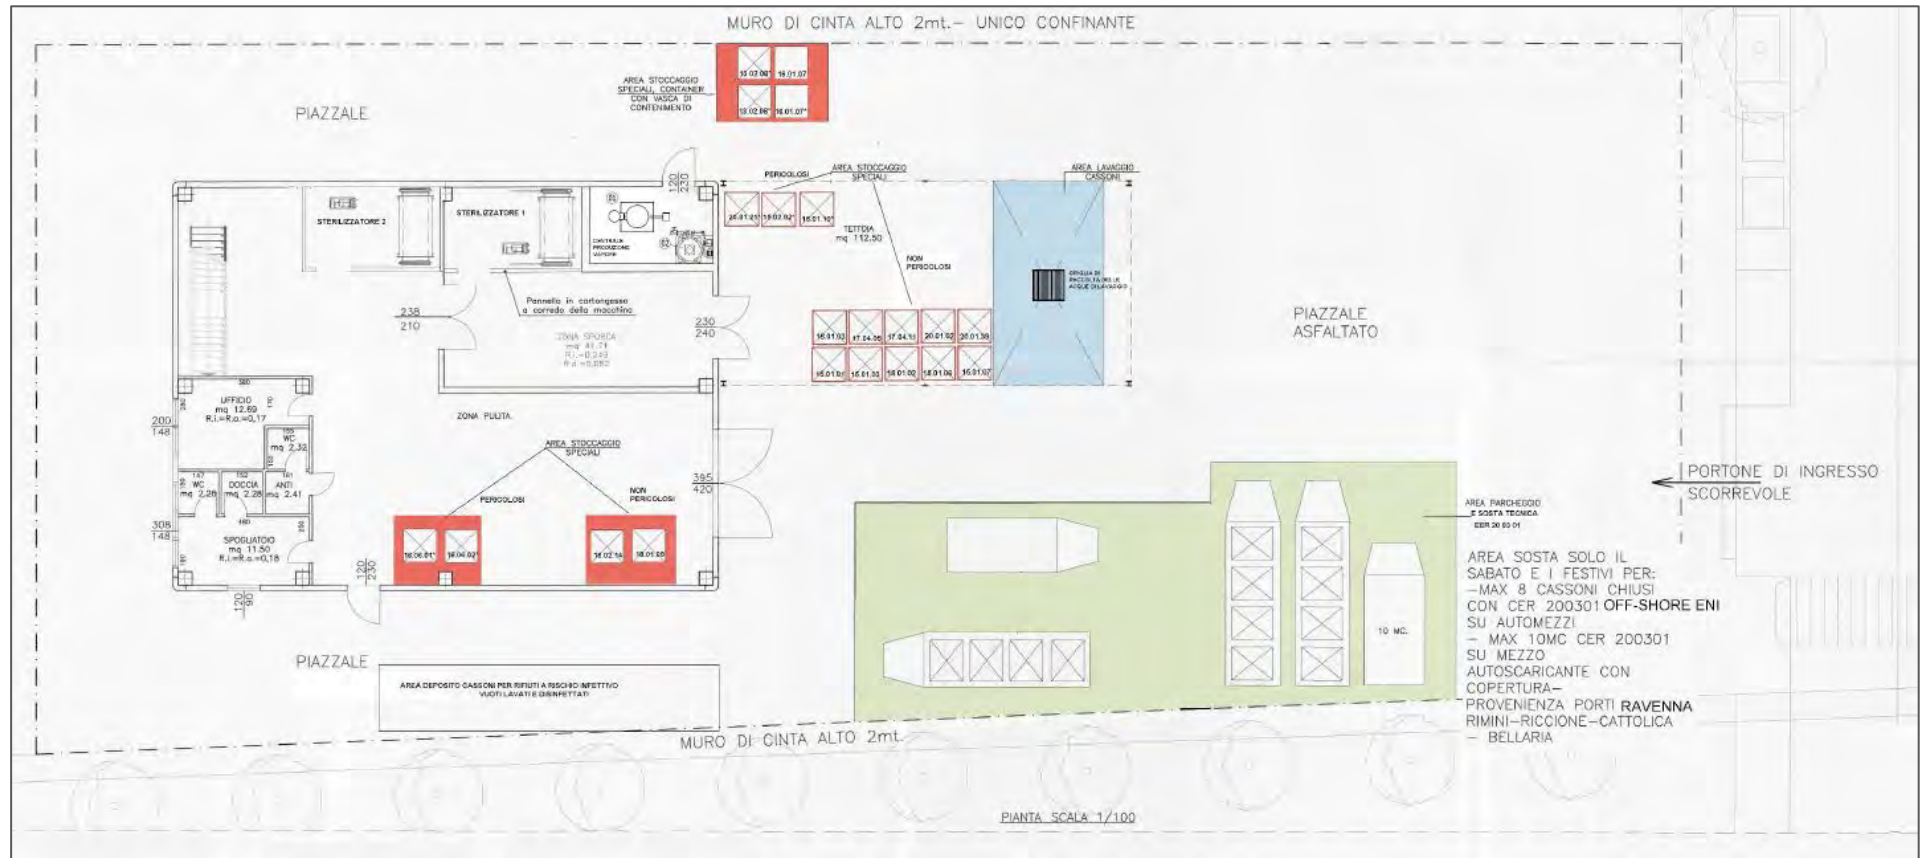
Planimetria dell'impianto Simap di via Depretis
